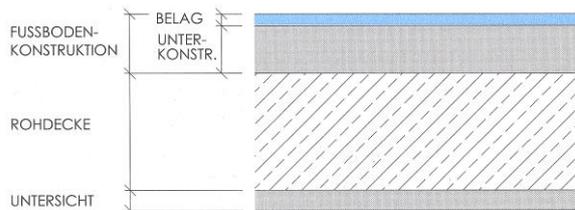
Aufbau einer Rohdecke mit Fußbodenkonstruktion
